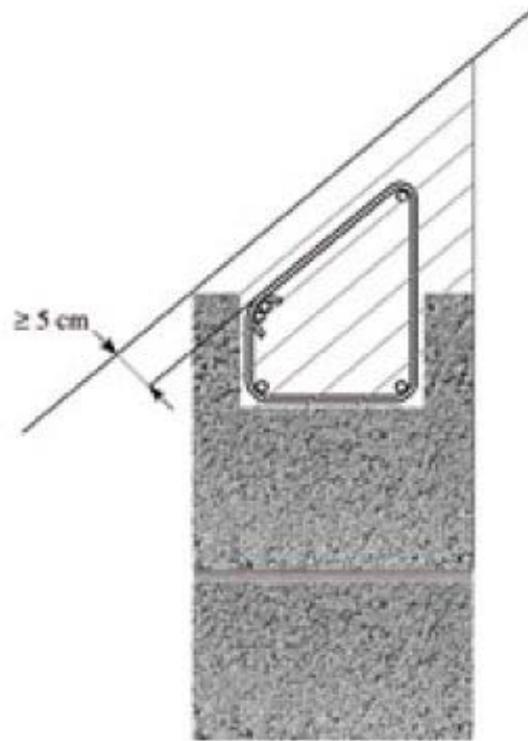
Enrobage des aciers du chaînage horizontal situé sous la toiture
